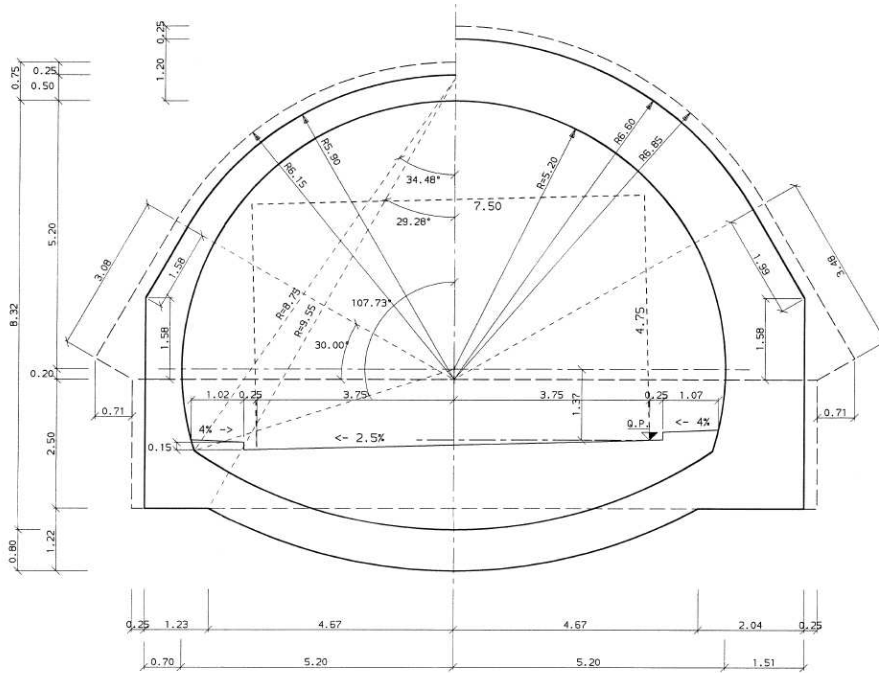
PE GEODATA 1996 – Galleria Guinza - Sezioni Tipo F – Carpenteria
